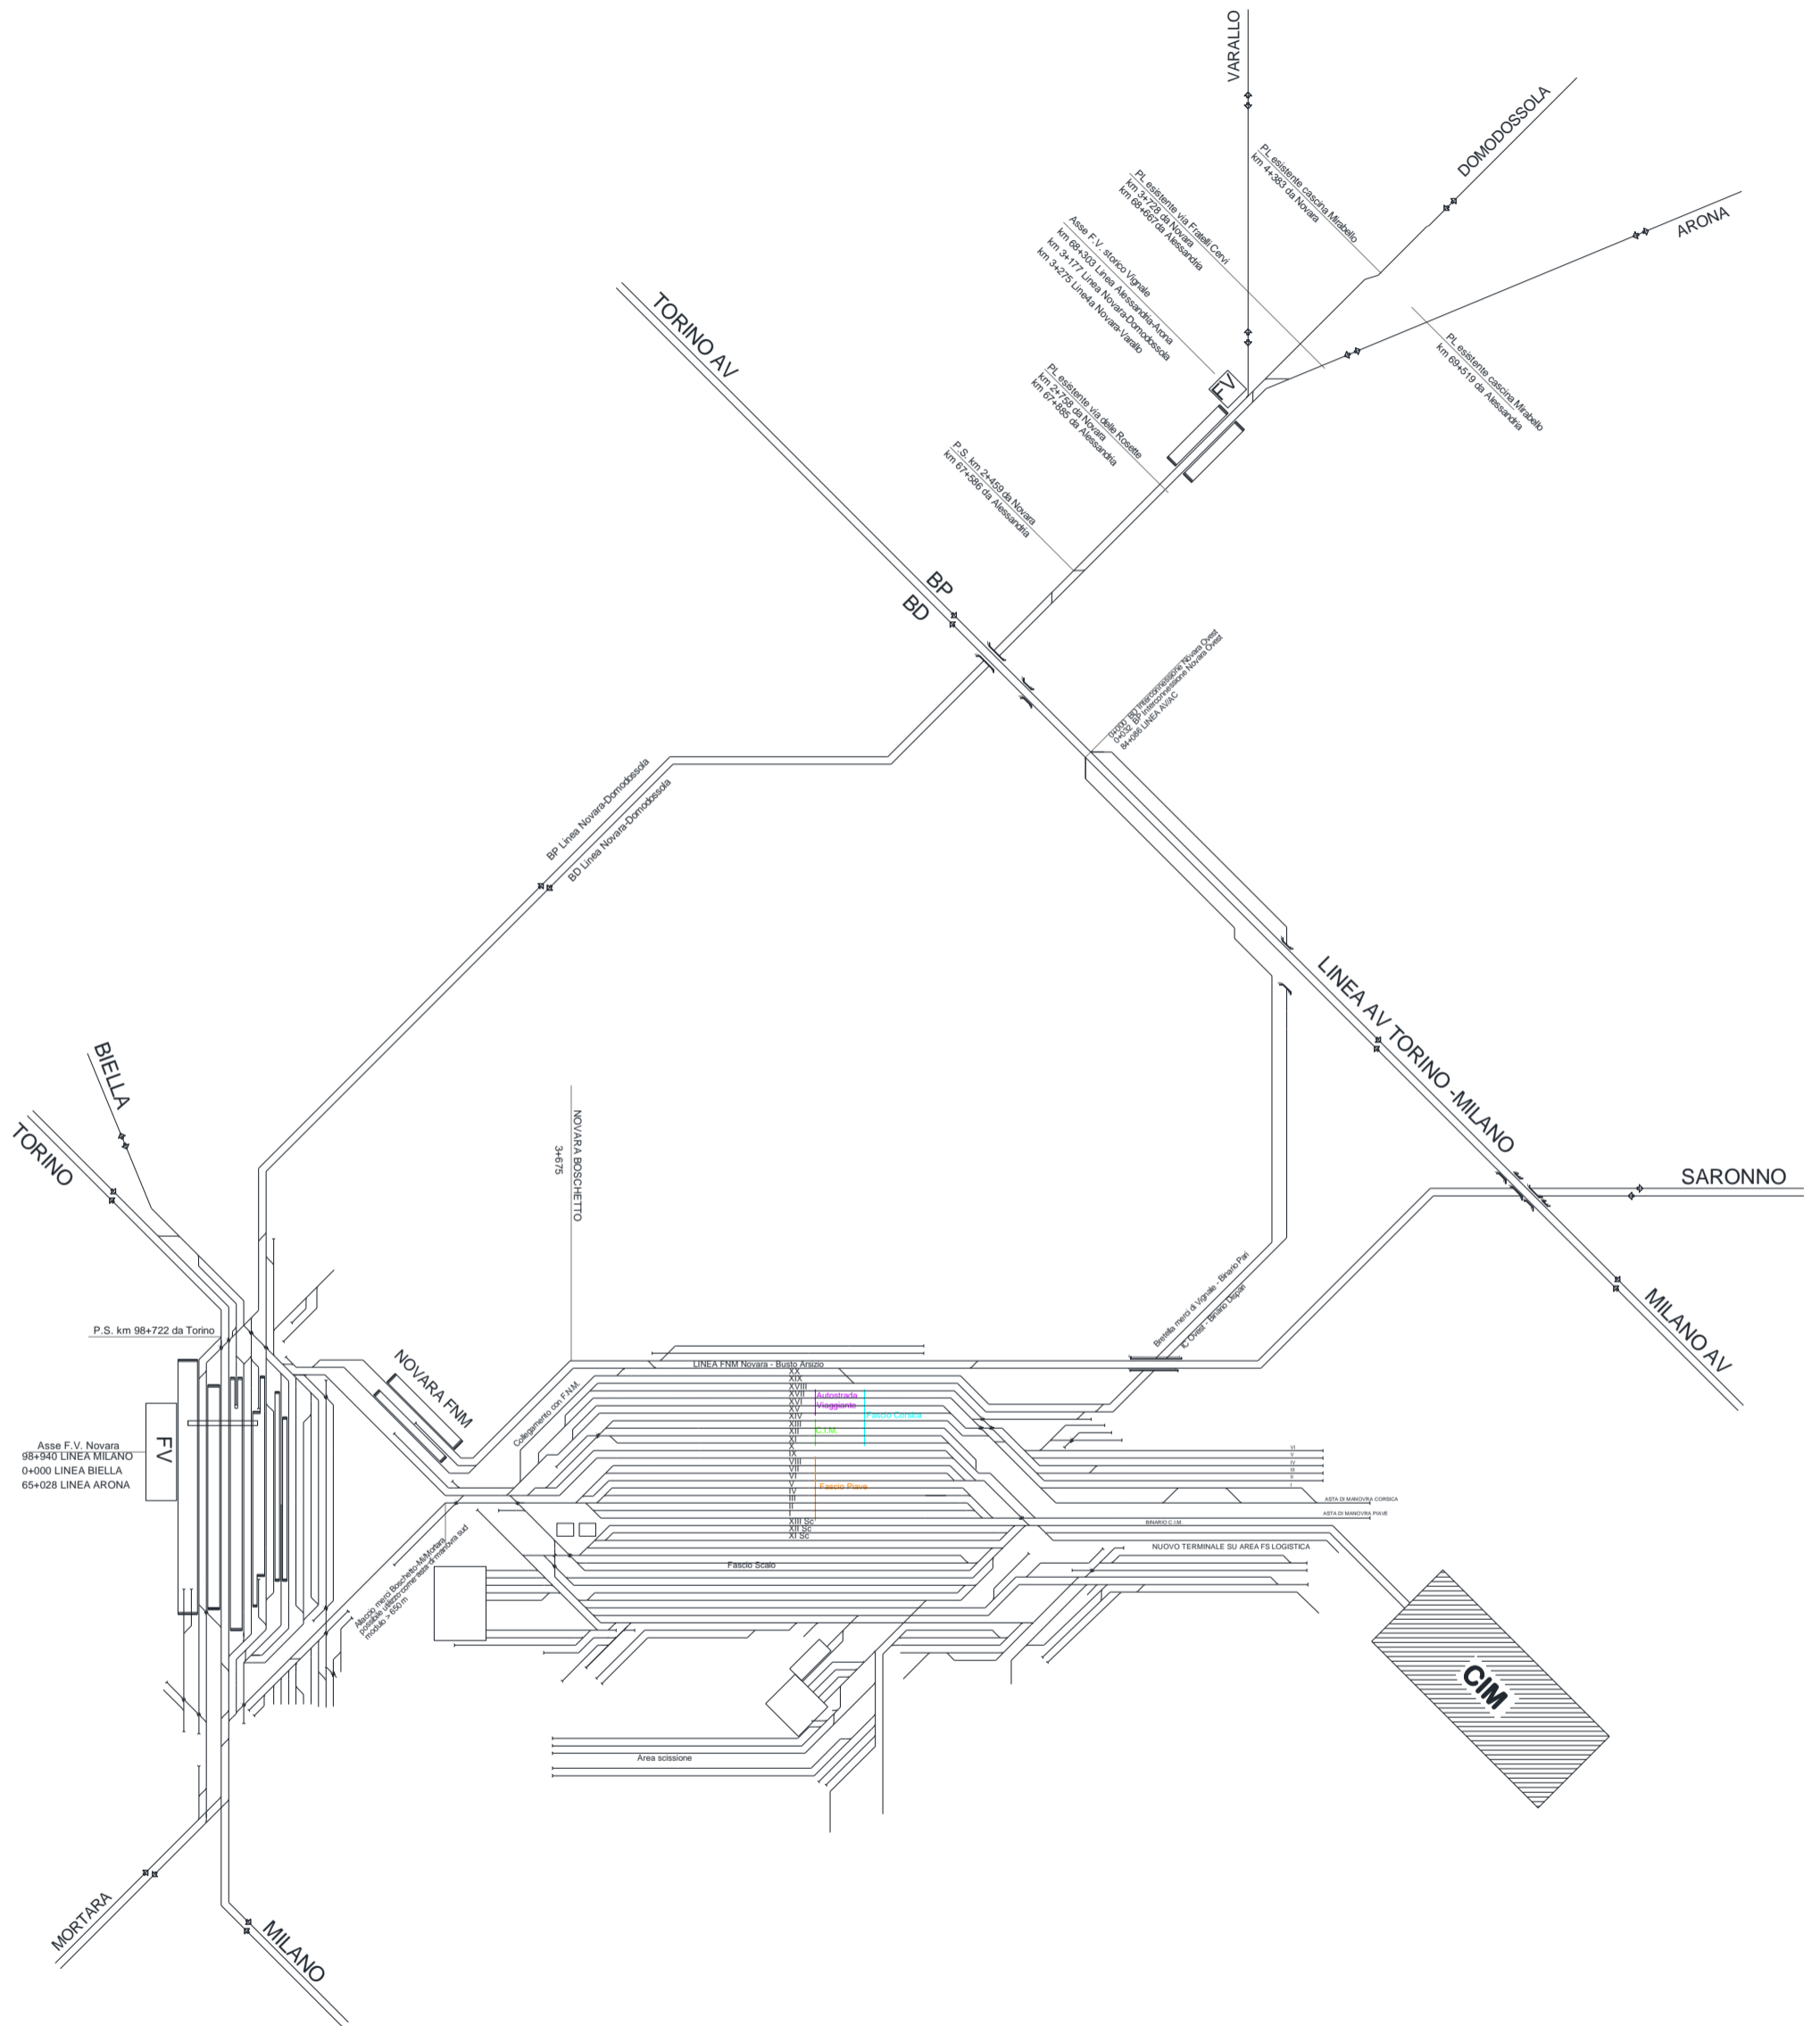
LAYOUT SCHEMATICO NOVARA BOSCHETTO
